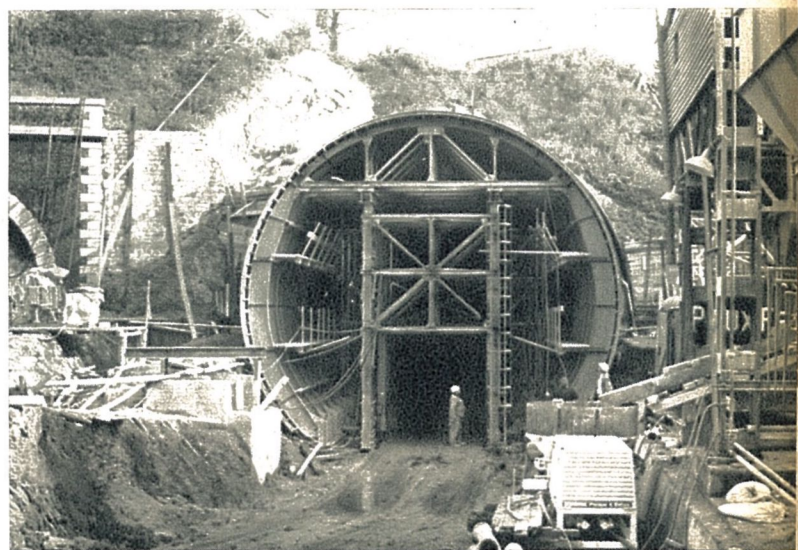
montage du support de coffrage pour le bétonnage de la voûte.
